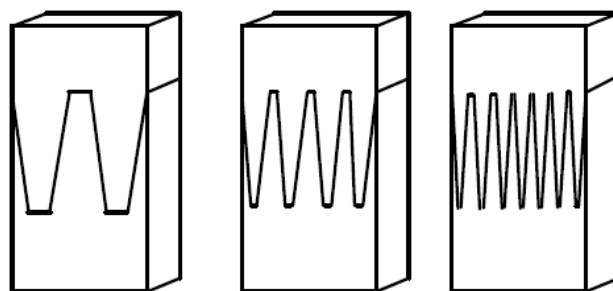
Emendas dentadas (*finger joint*) (SERRANO, 2009)
